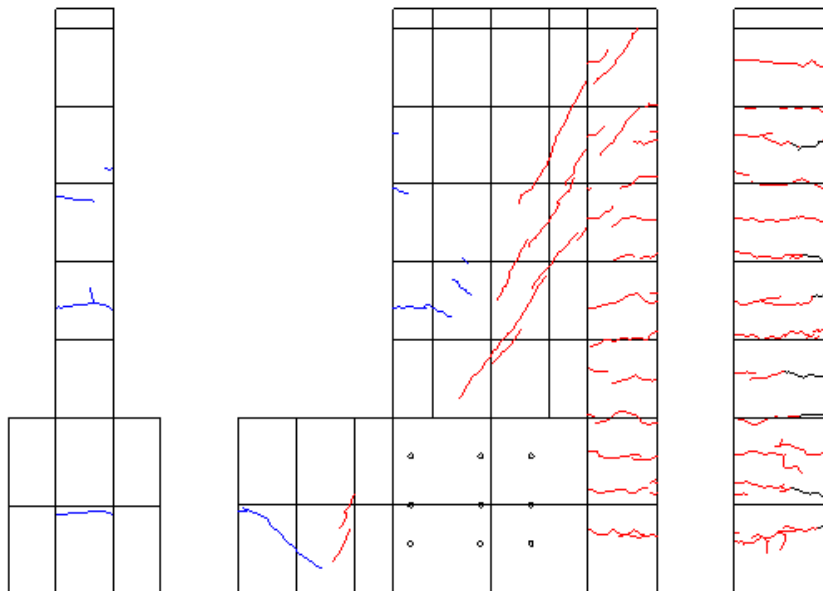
R=1/200②ひび割れ図
